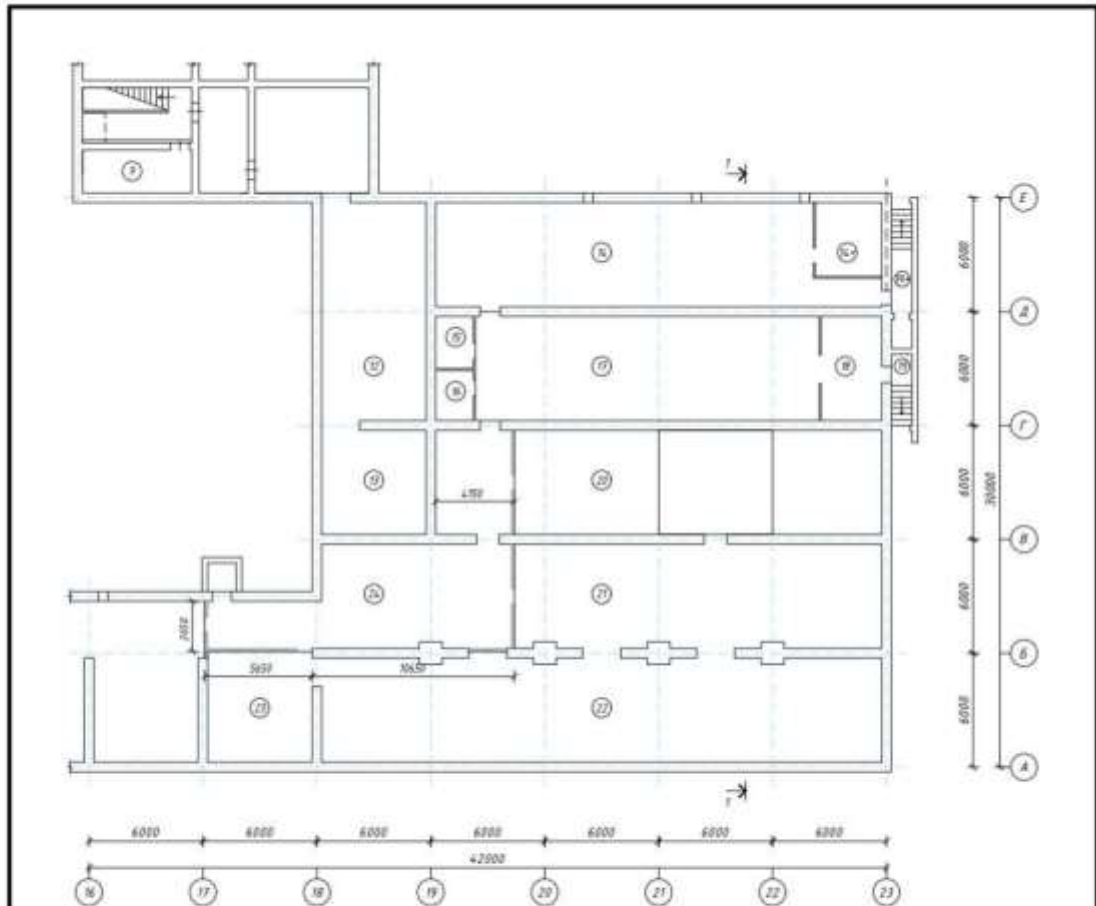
Фрагмент плану підвалу (обмірне креслення)
